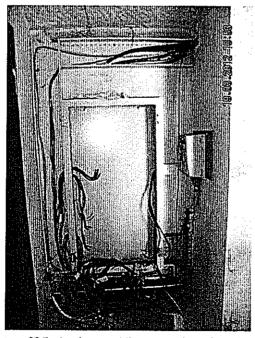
Androne- Vista quadro elettrico e cablaggio
